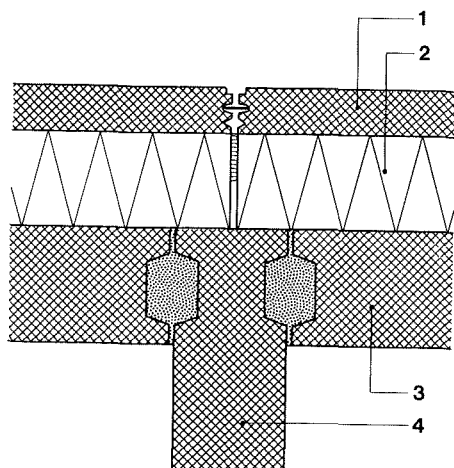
Samling mellem dobbeltvæg af letkonstruktionsbeton og ydervæg af mursten og letkonstruktionsbeton. Vandret snit 1:10.
